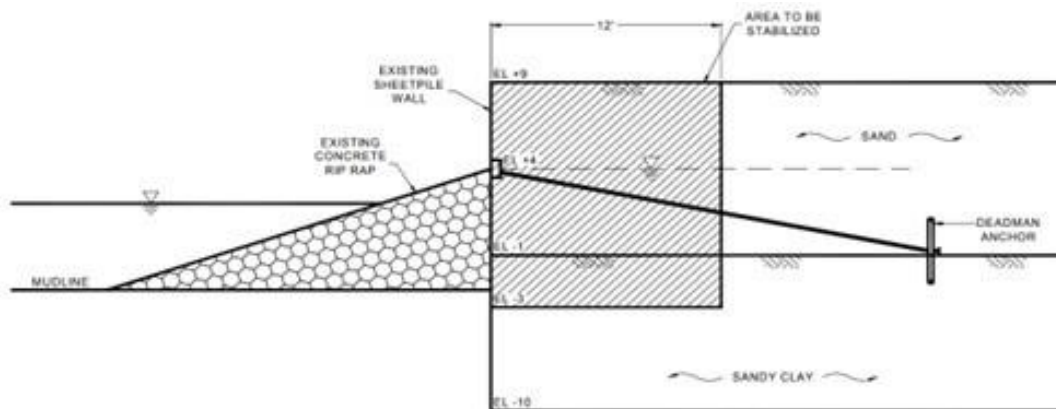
Поперечное сечение шпунтовой стенки после устройства грунтоцементных колонн [15]
